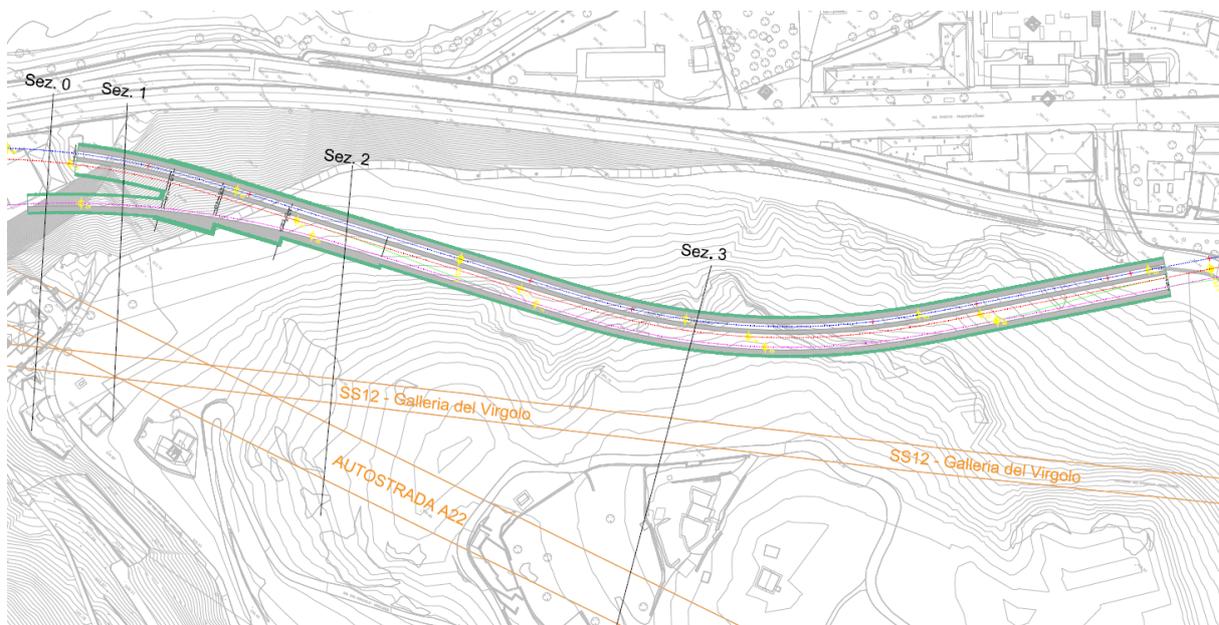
Planimetria dell'opera in sotterraneo con sezioni
